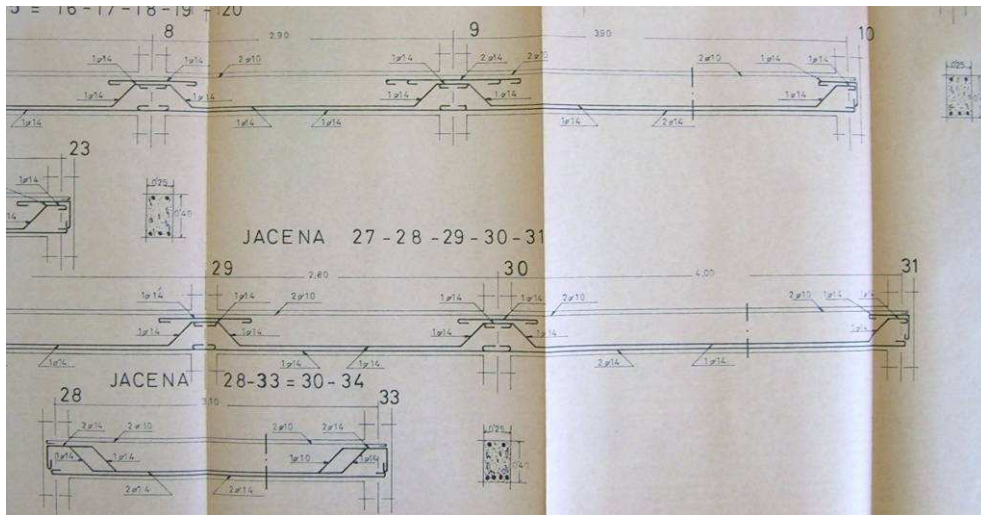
Plano estructura, Edificio ficha 152C.011, 1963.
